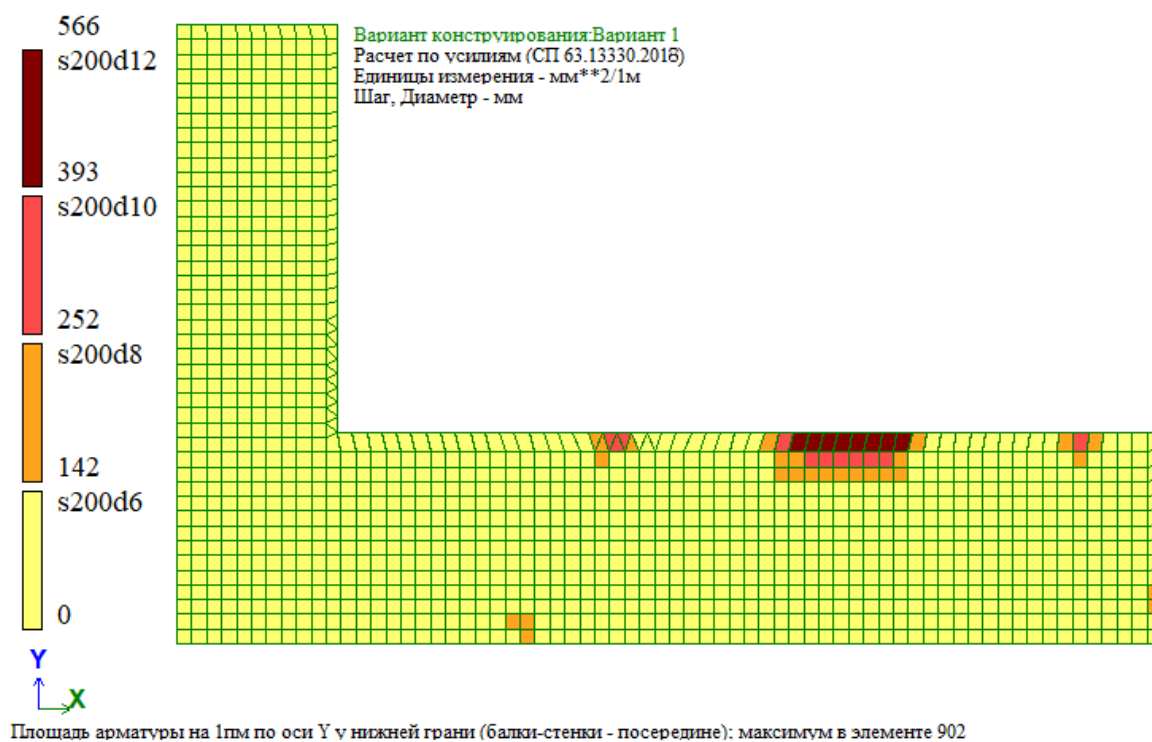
Подбор продольной арматуры по нижней грани вдоль оси Y
